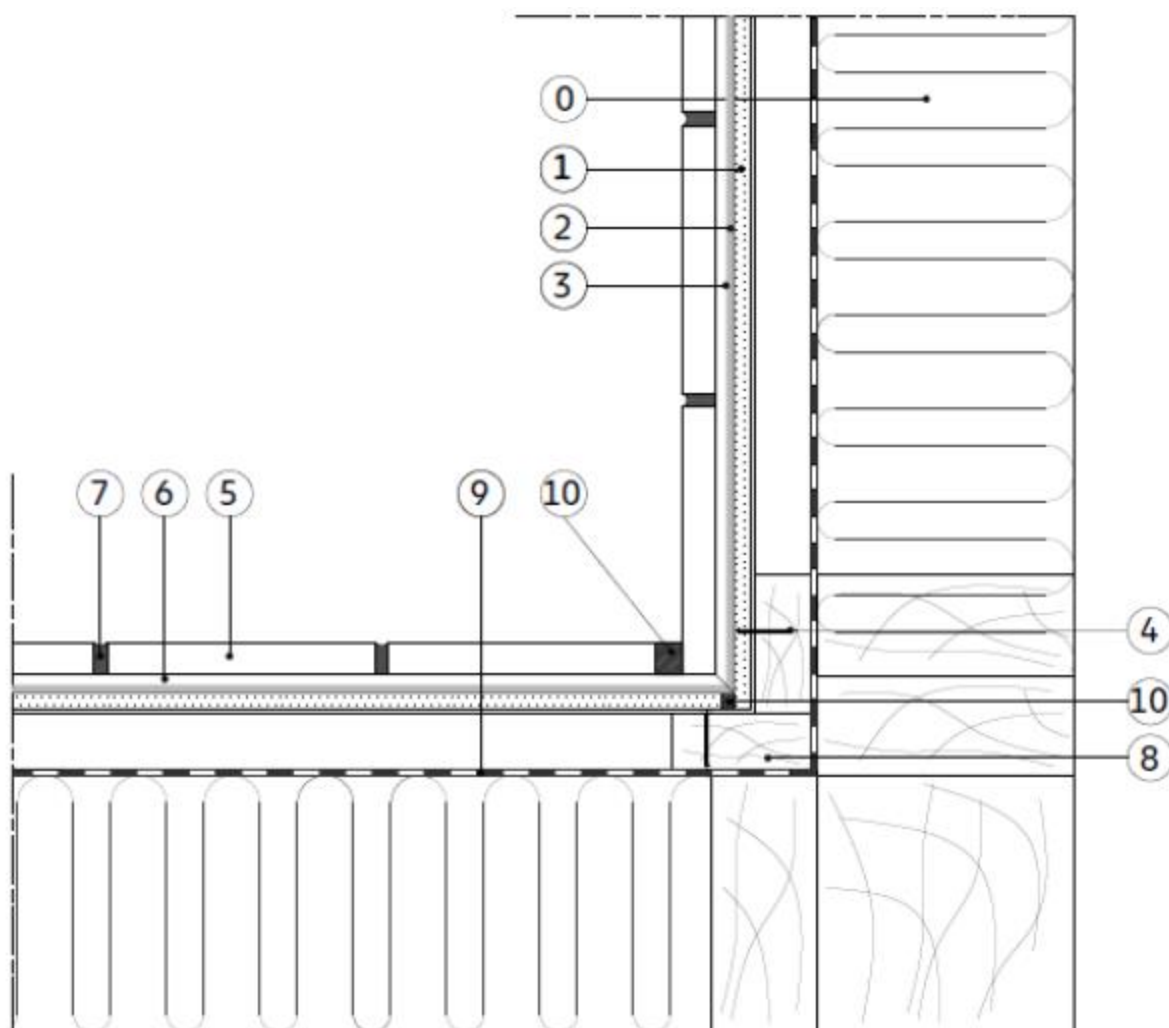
COB, CLT Coupe verticale sur le fractionnement du bardage avec recoupement du pare-pluie
